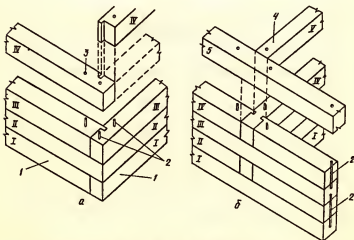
Схемы сопряжения брусков наружных (а) и наружной и внутренней (б) стен на торцевых шипах:
